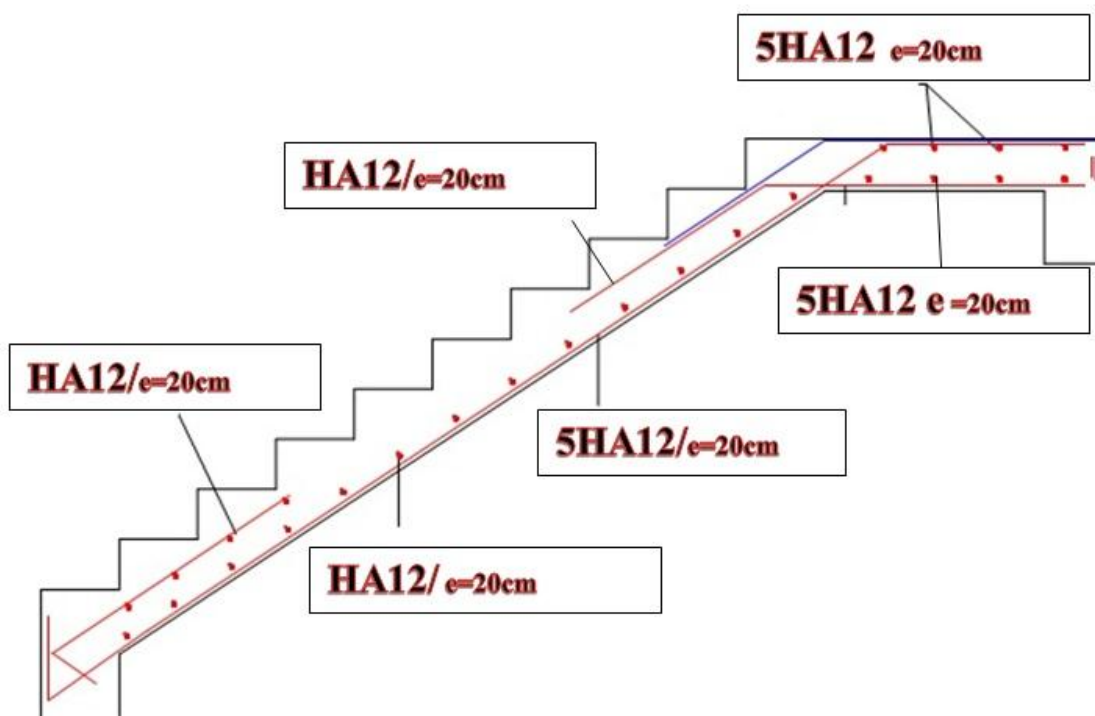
Schéma de ferrailage de l'escalier.
